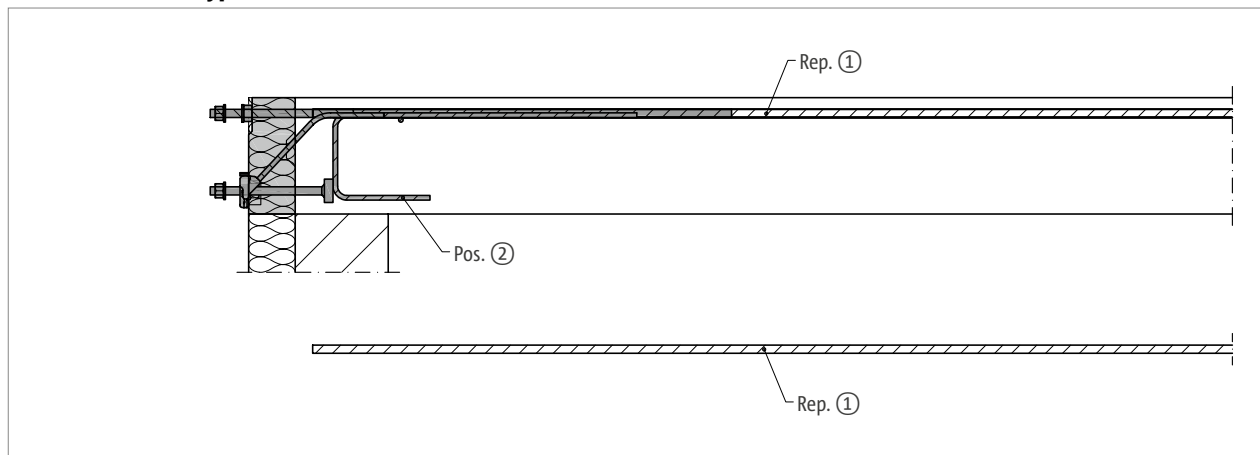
Schöck Isokorb® T type SK-M1 : renforcement sur site, coupe
